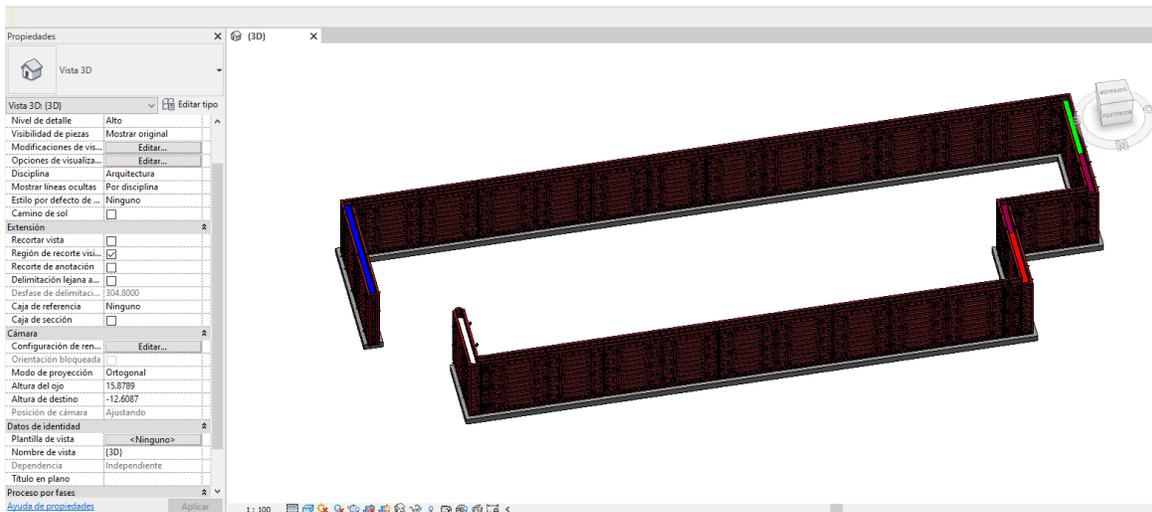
Vista del muro una vez colocados los elementos de encofrado sobre él. Fuente: elaboración propia
